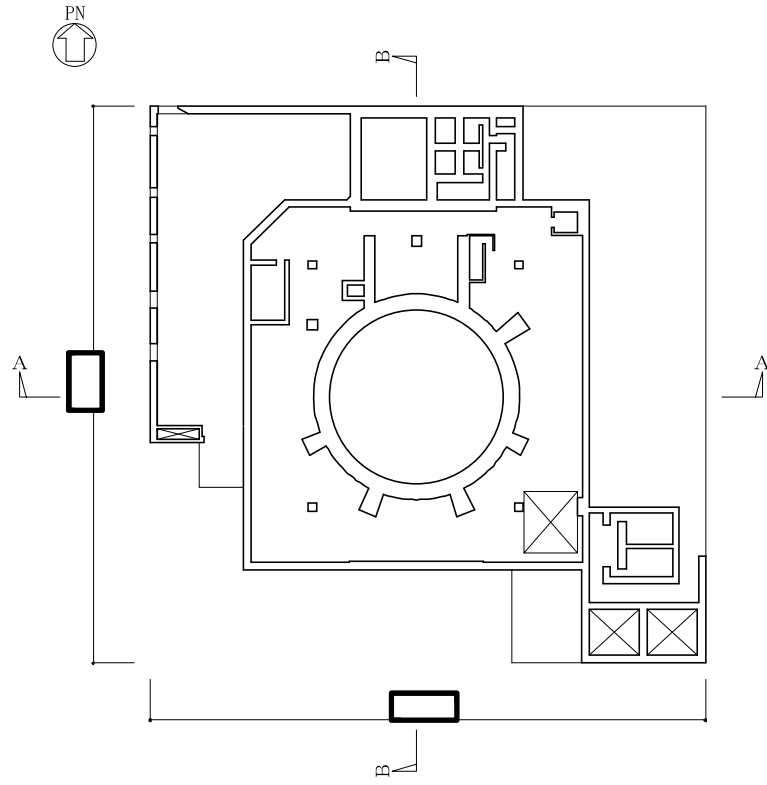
(5/9)  の概略平面図 (EL. 20.3 m)
